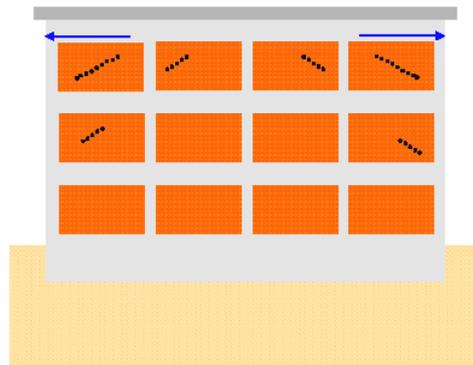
Fissuras de corte nas alvenarias, provocadas pela movimentação térmica da estrutura
